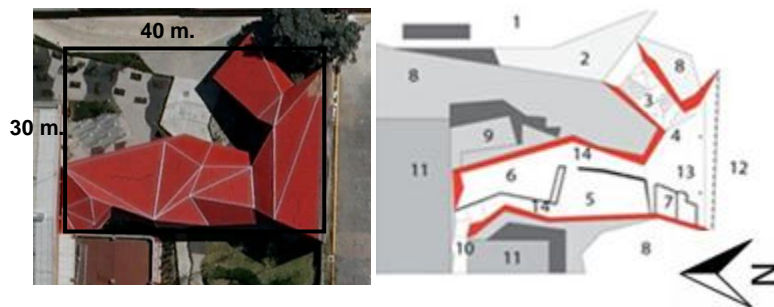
Museo del Chocolate en vista aérea (izquierda) y planta arquitectónica. (derecha) (<http://www.arqred.mx>, 2009)
